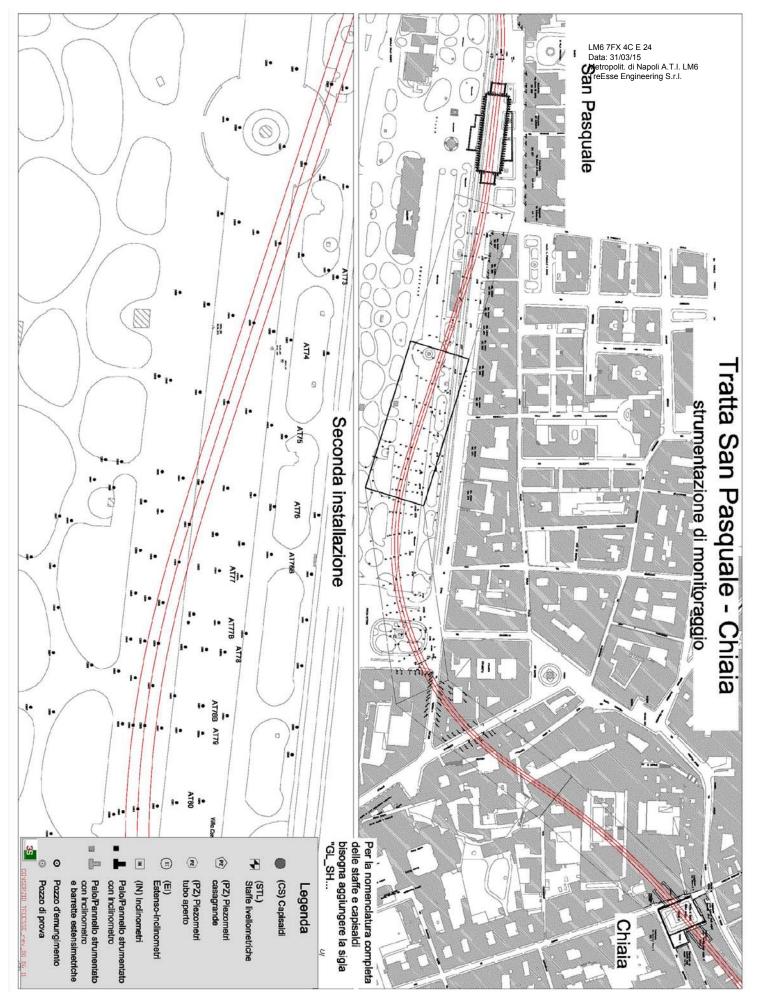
Planimetria tratta San Pasquale - Chiaia, raffigurante la disposizione della seconda installazione della strumentazione di monitoraggio.
